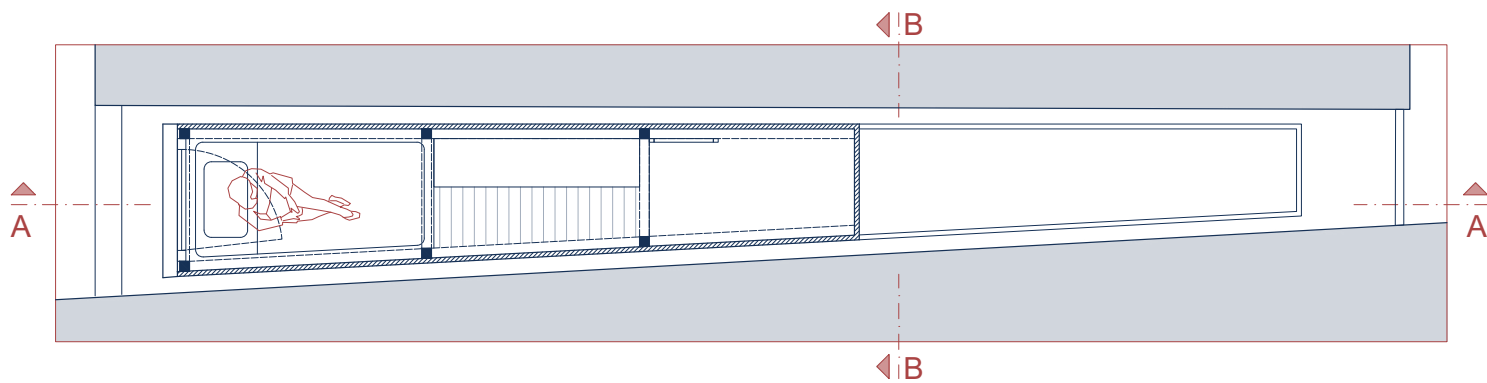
Pianta piano primo, rielaborazione propria - scala 1:50
